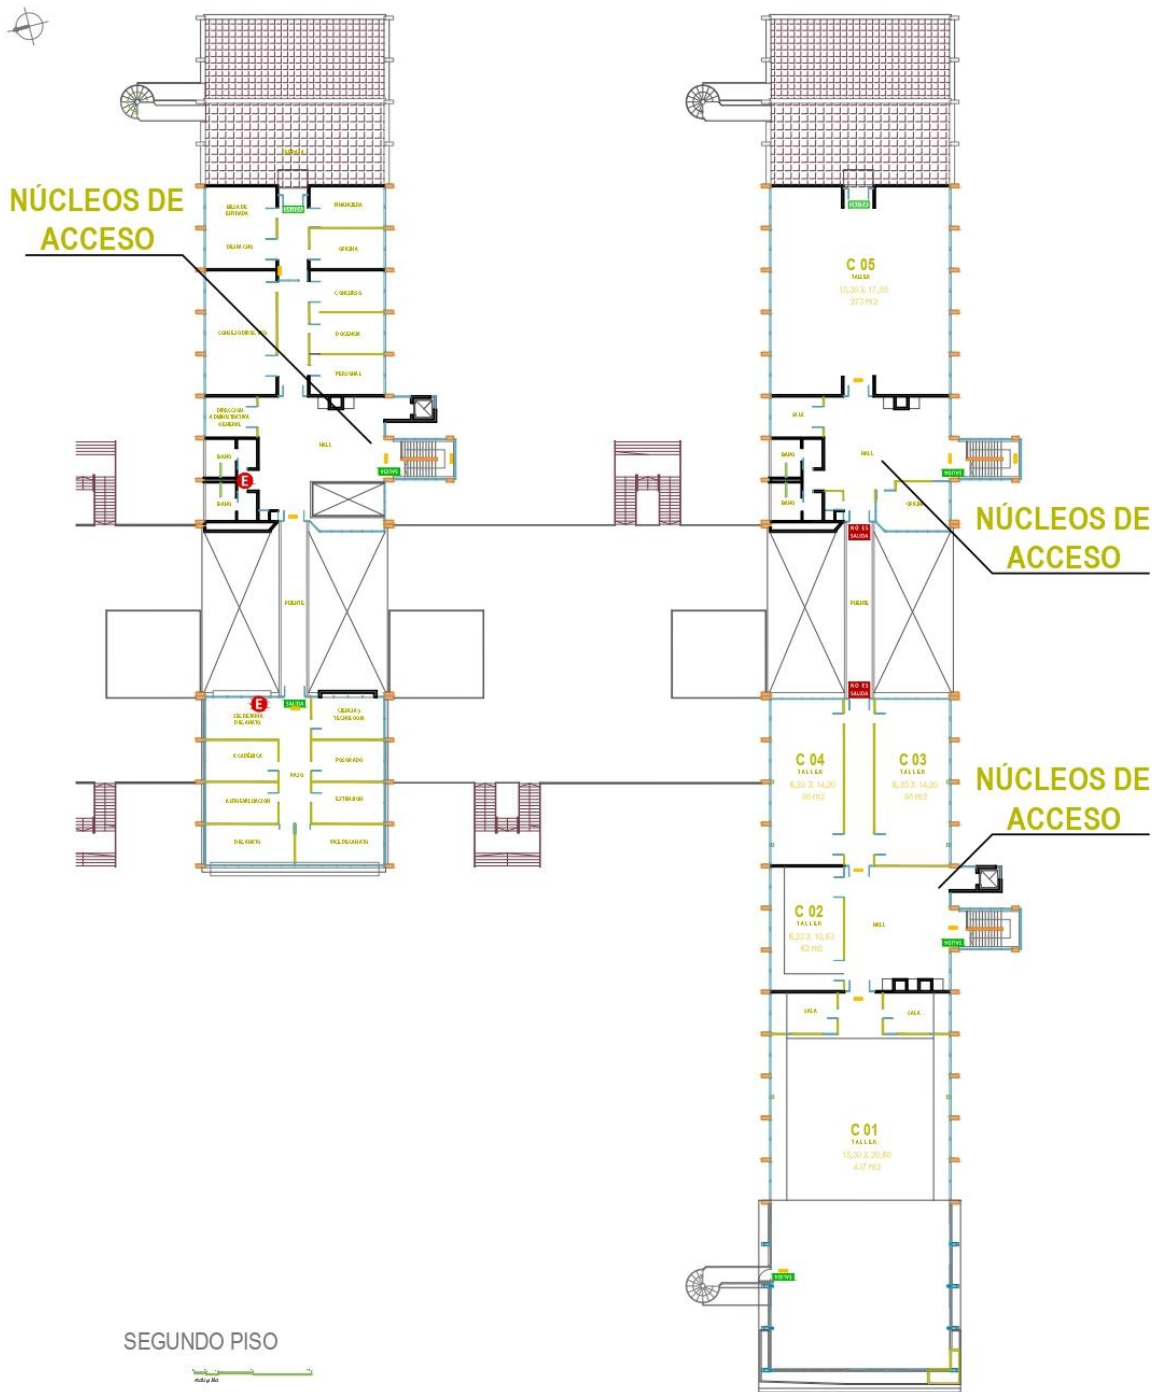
Plano segundo piso edificio FAPyD. Fuente: elaboración propia.
